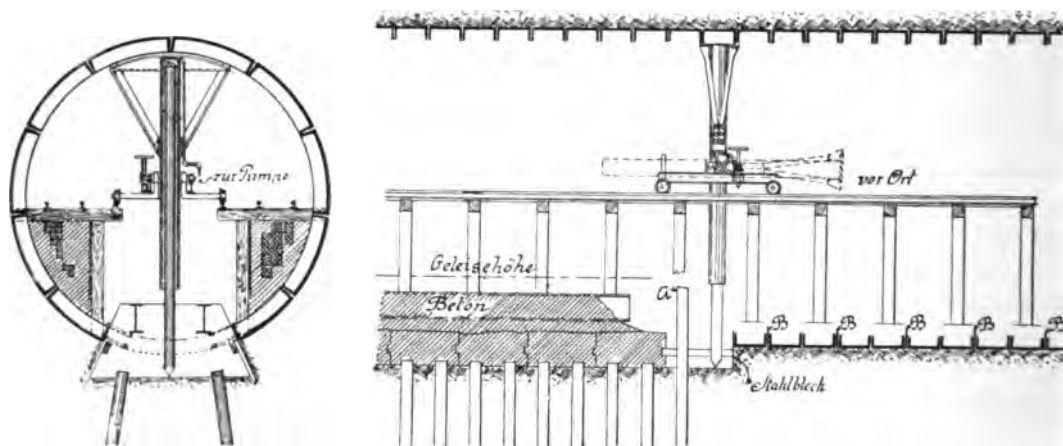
Vorgeschlagene Gründung des North River-Tunnels.
